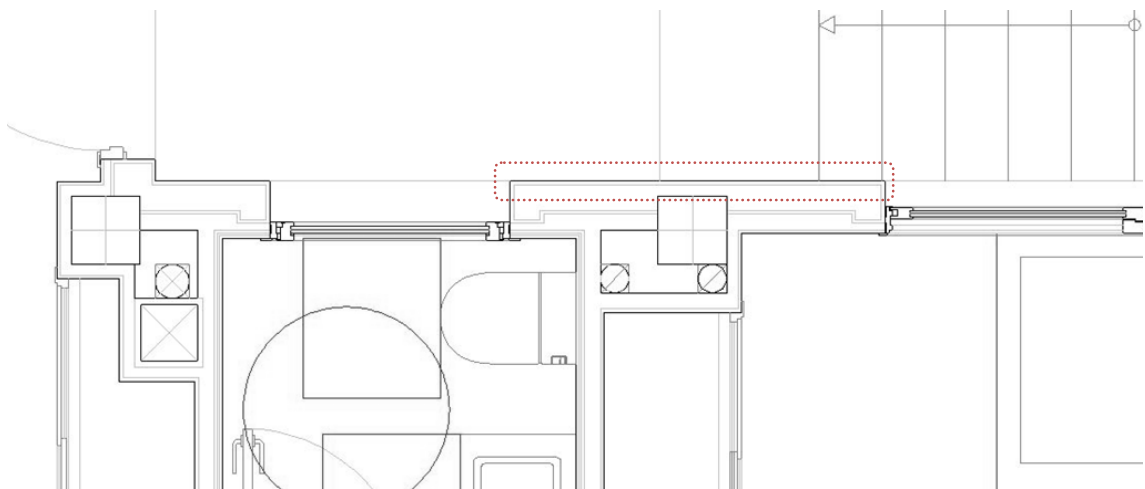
Revestimiento en planta del Proyecto en AutoCad. Fuente: .dwg Hadit Arquitectos
